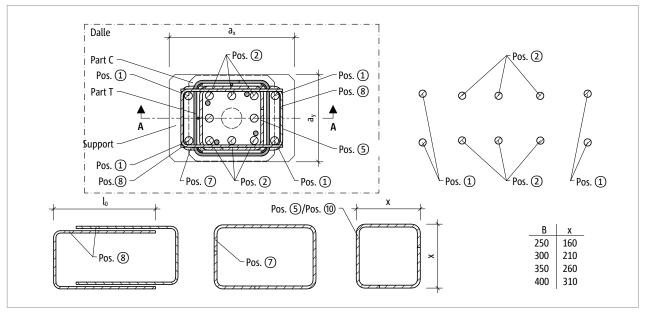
Schöck Sconnex® type P : renforcement sur site dans la section du poteau
